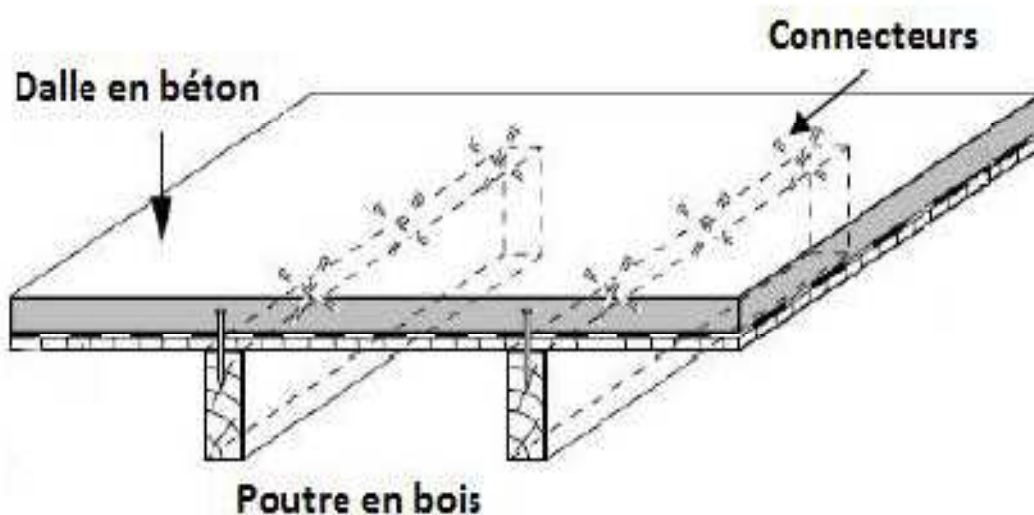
Schéma de principe d'un plancher mixte en bois-béton.
